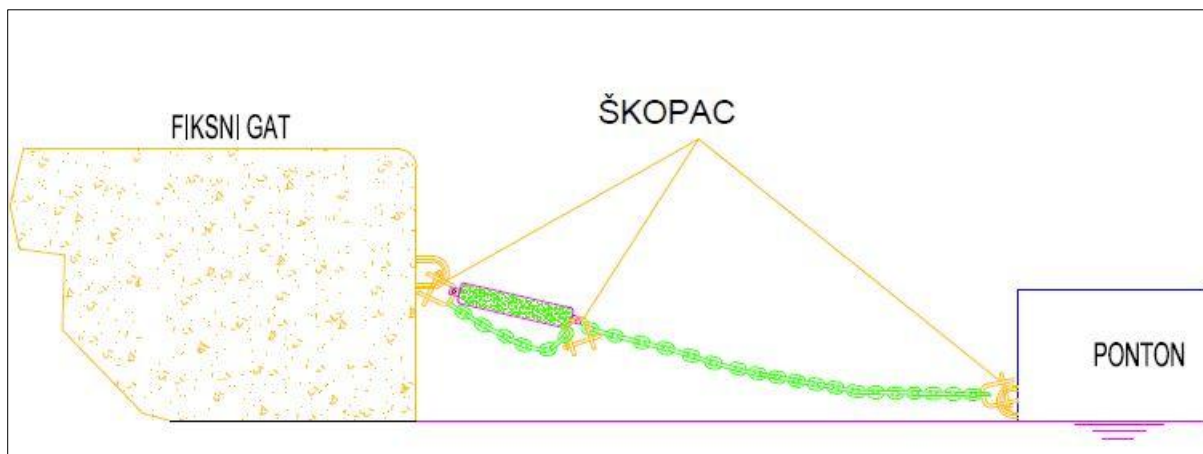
b: Prikaz planiranog stanja postavljanja plutajućeg pontonskog elementa u produžetku gata G (Izvor: Planirana situacija-MARINA VODICE-gat G, Levant d.o.o. Murter, svibanj 2020.)
